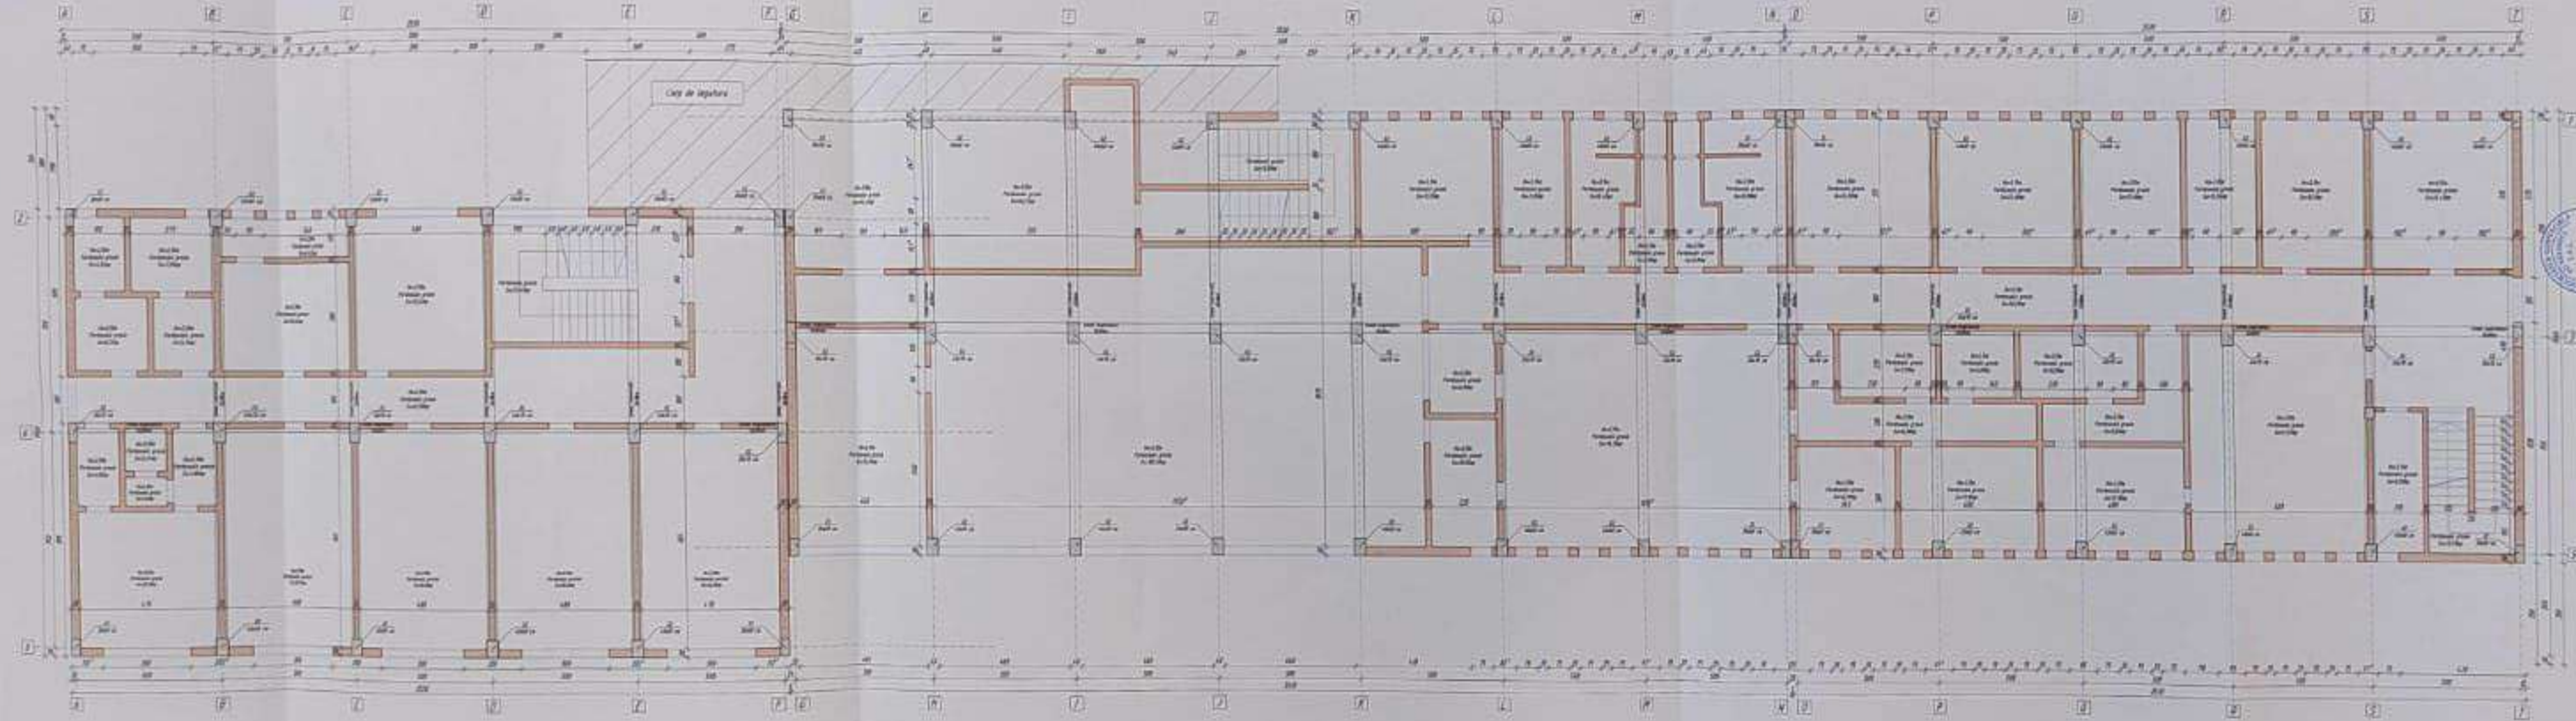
Plan dispunere stalpi, grinzi si pereti din beton subsol
